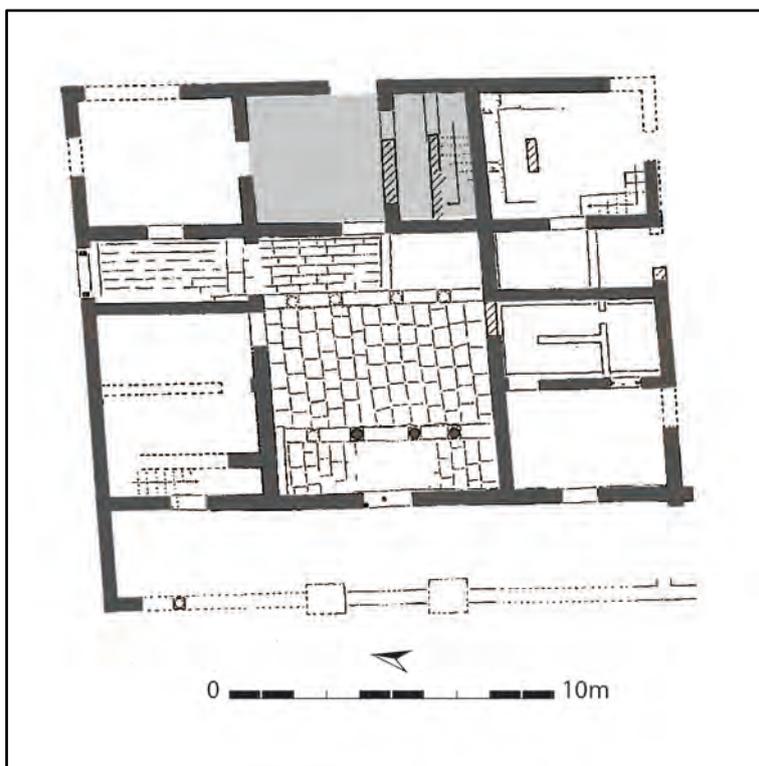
Abu Mina: planimetria della abitazione detta “*Ostraka House*” (VI sec.).
